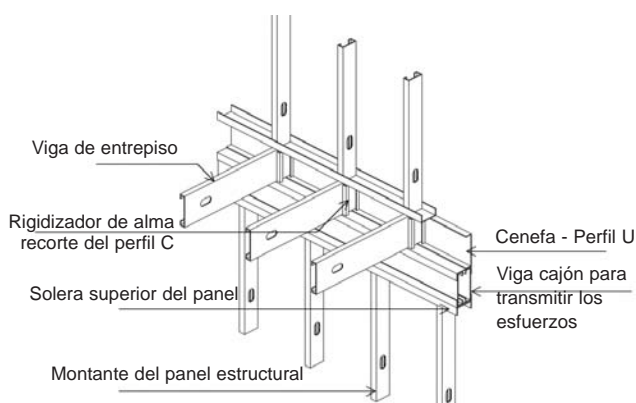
Viga de distribución de la carga del entrepiso a los montantes
